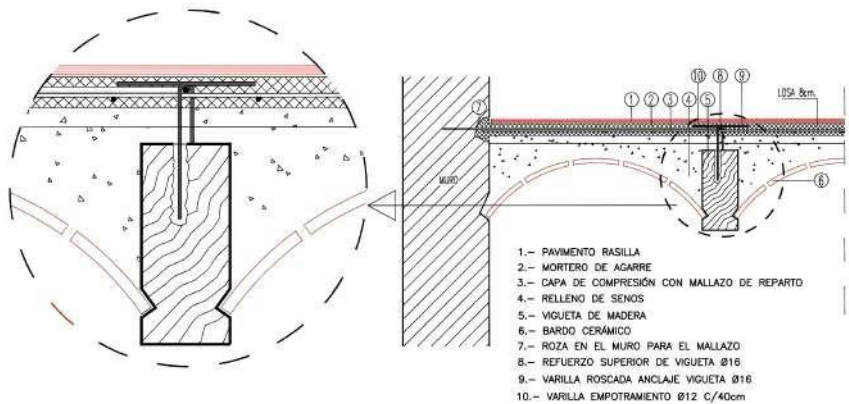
Propuesta intervención forjado vivienda. Fuente propia
